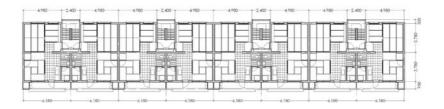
改修前の平面図 / Building Floor Plan before Renovation
